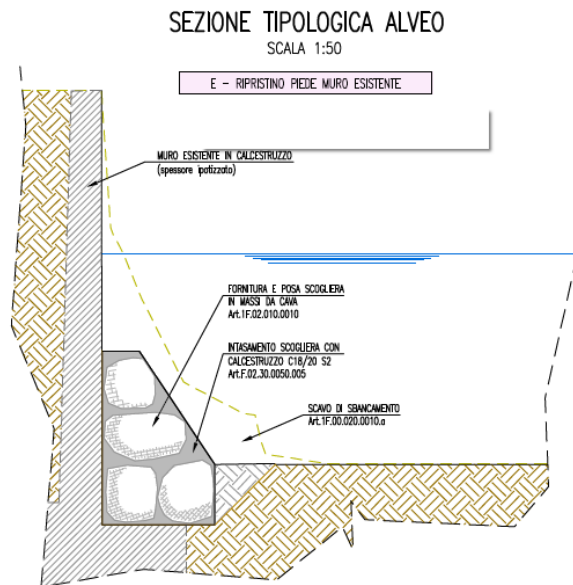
Estratto Tavola 17. Sezioni tipologiche e particolari. Dettaglio dell'intervento E – Ripristino piede muro esistente.
